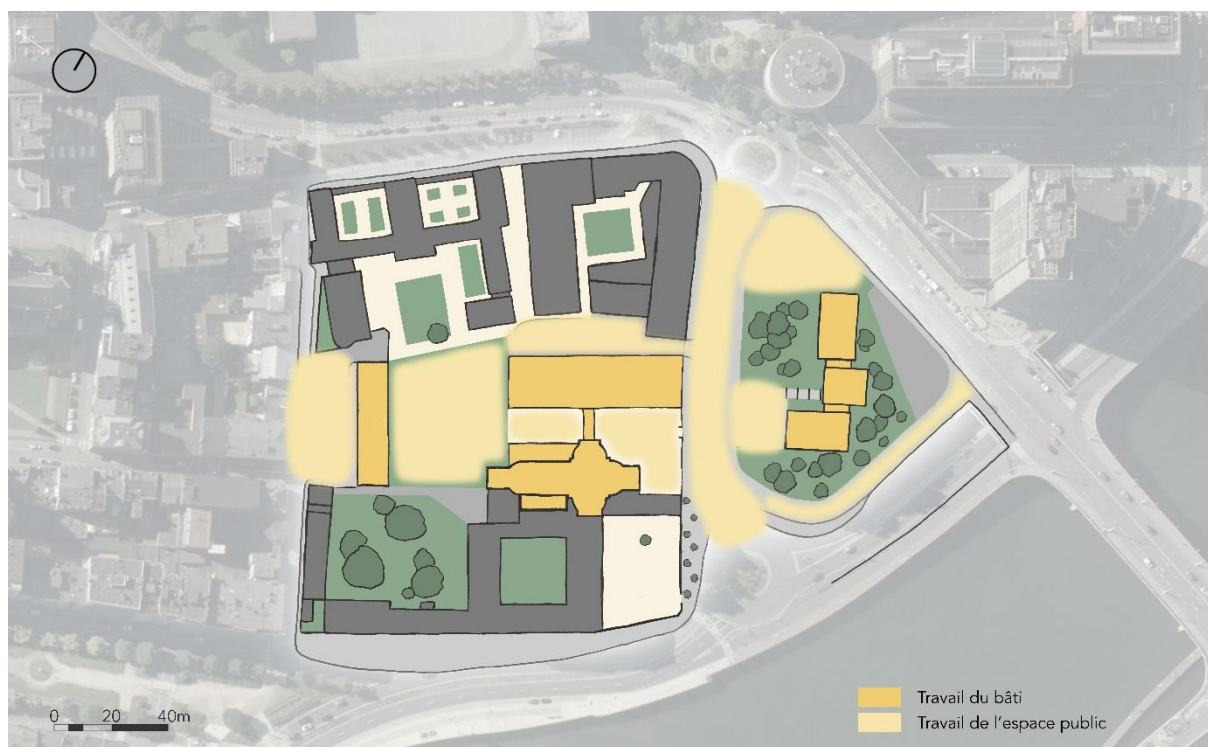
Répartition des zones de réflexion sur le bâti et les espaces publics (fond de plan WalOnMap, 2016)
